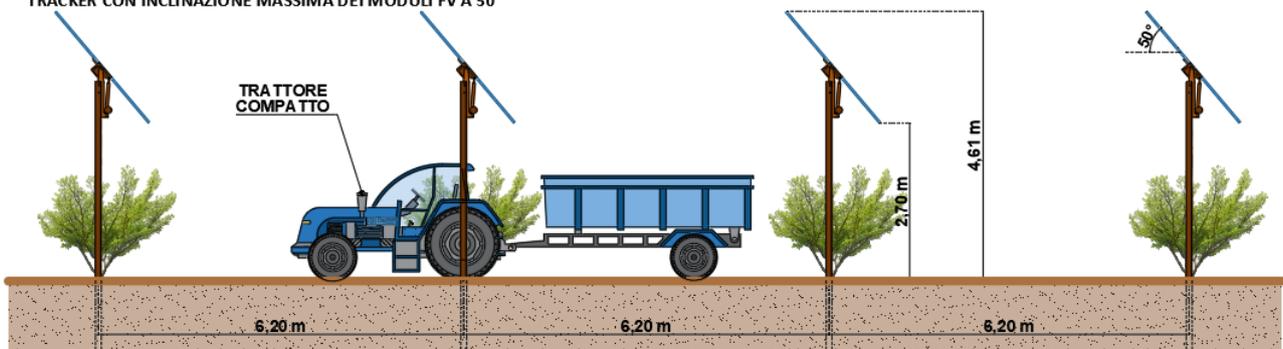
Particolare disposizione moduli su tracker: evidenza altezze dal suolo
